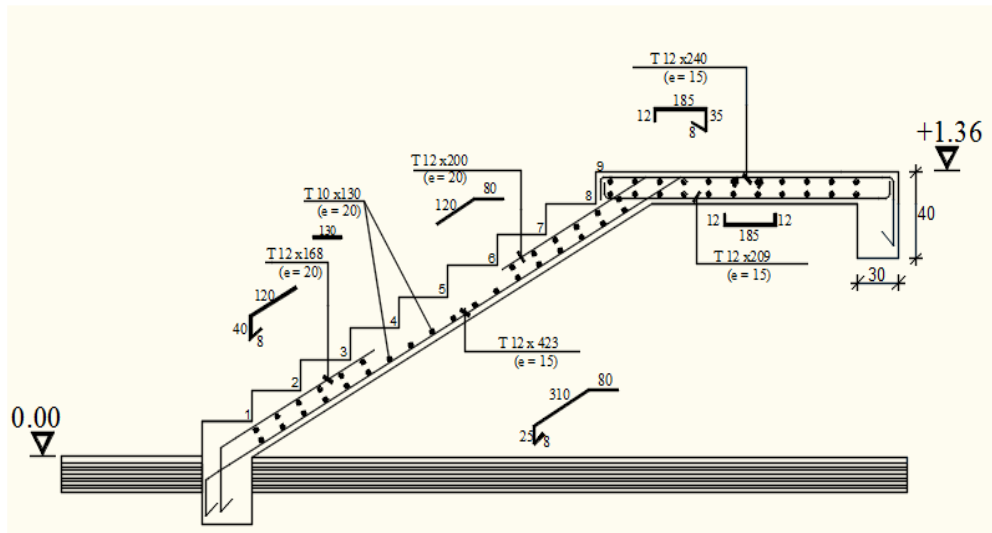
Dessin de ferrailage de l'escalier à paillasse porteuse.
